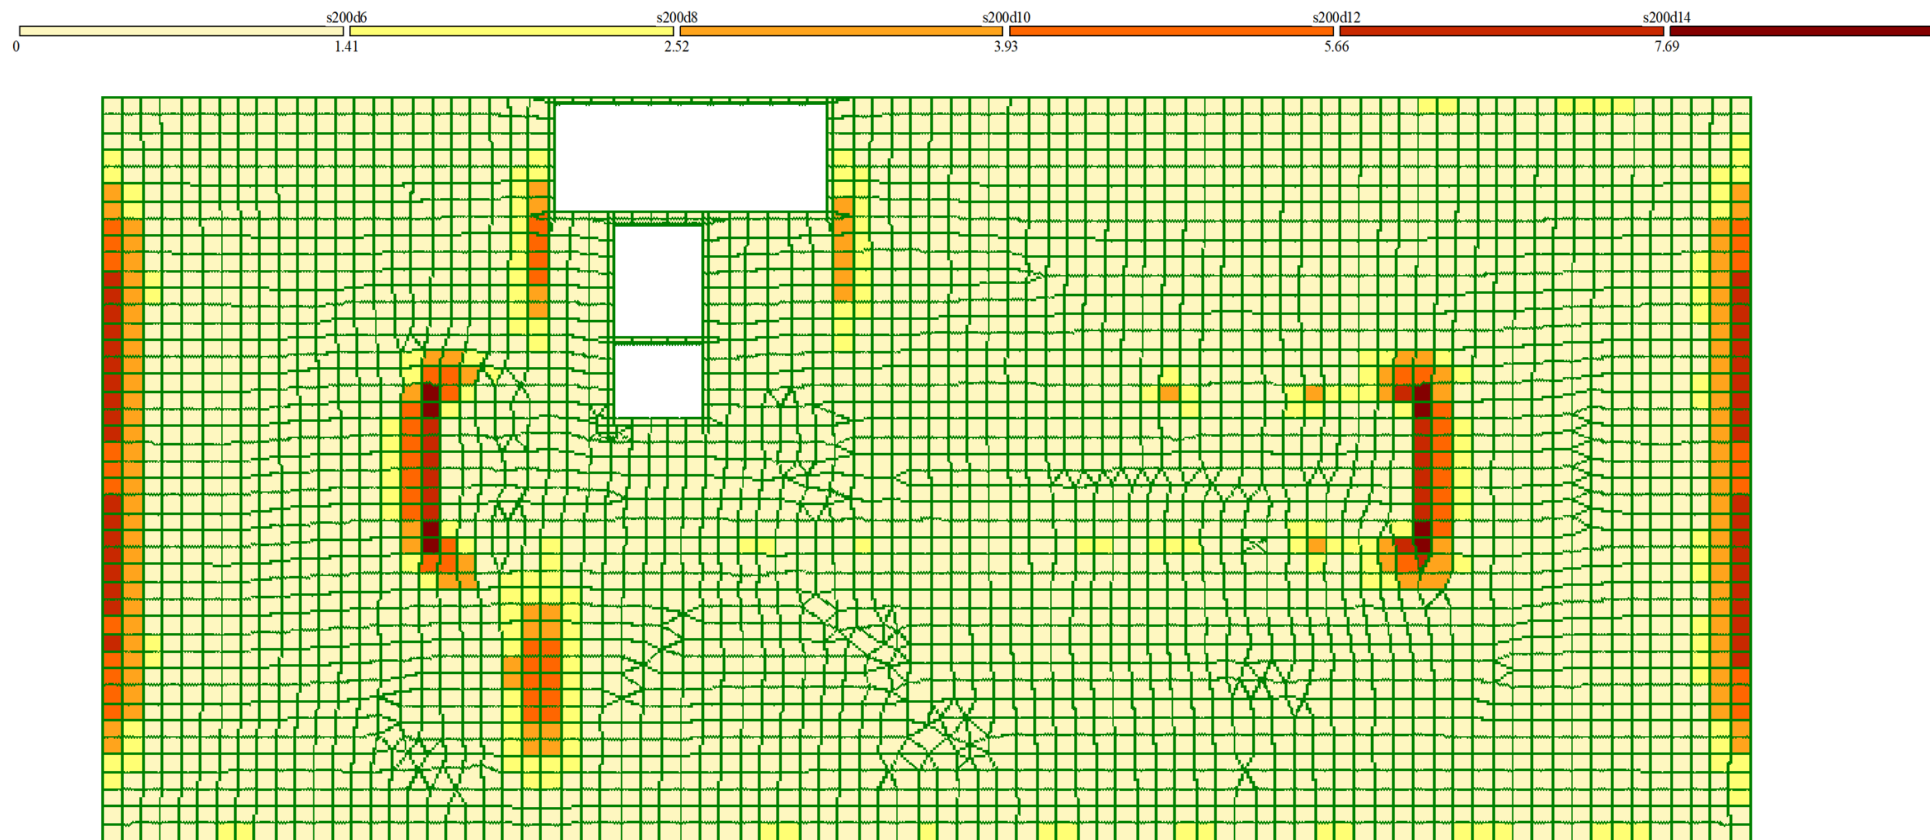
Площадь арматуры в направлении У, верхняя зона
